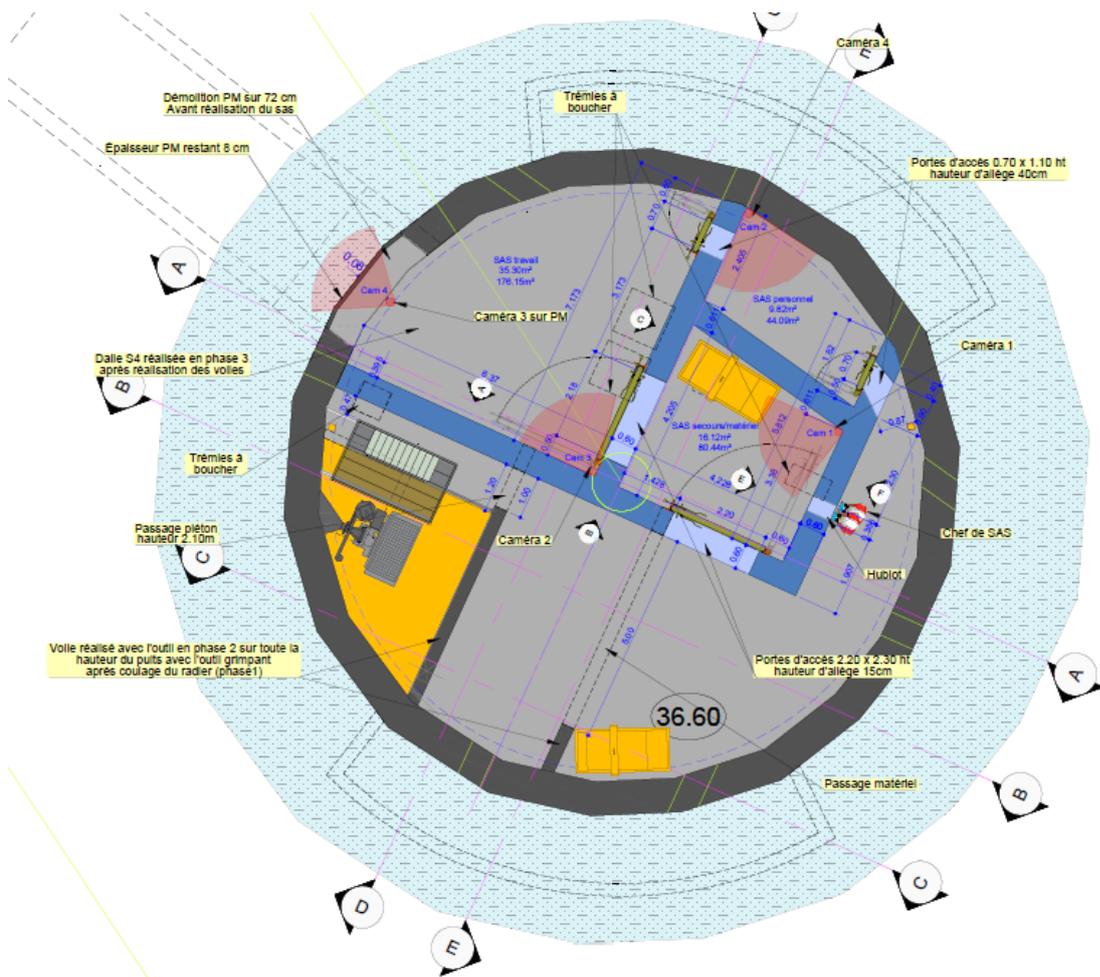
Vue en plan – Voile des sas (épaisseur 60cm)
